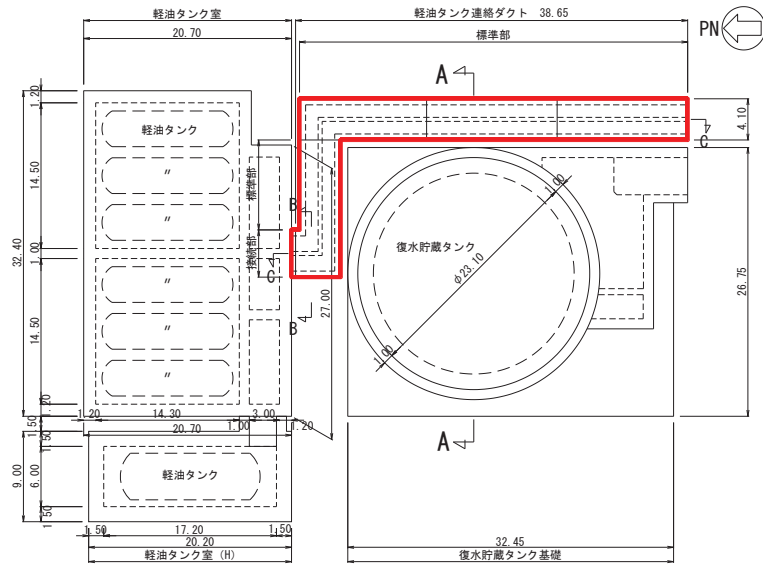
(1) 軽油タンク連絡ダクト平面図 (単位：m)
